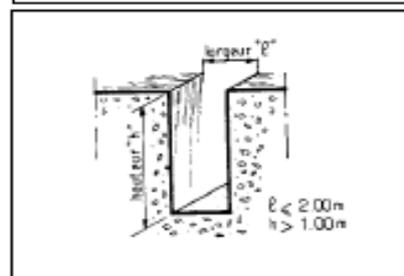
Fouilles en rigoles pour fondations : Elles correspondent aux semelles filantes (fondations sous les murs et les voiles de l'ouvrage). La quantifiées se fait en  $m^3$ .
